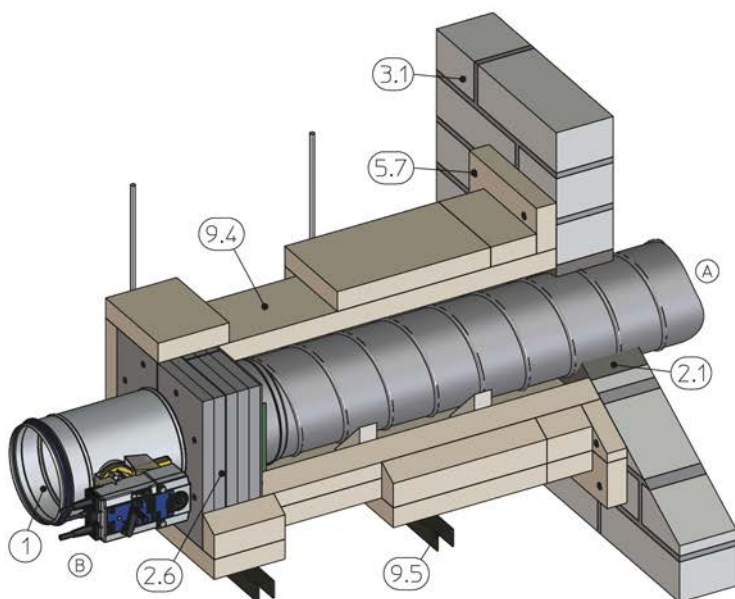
Монтаж без раствора на сплошные стены, с монтажным комплектом WA / WA2
